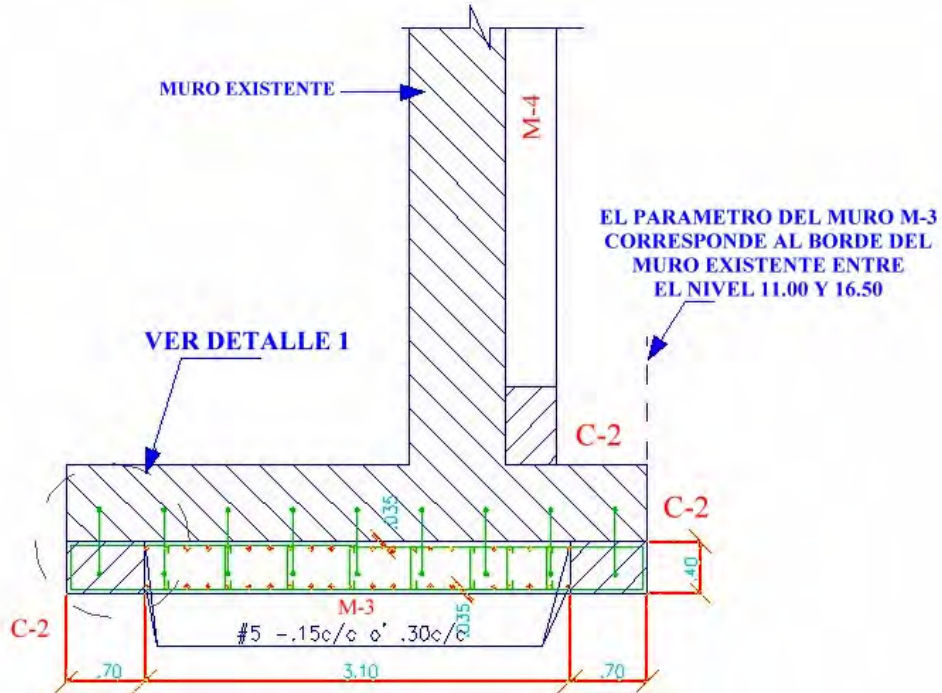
Detalle de plano de anclajes de uno de los muros adosados
